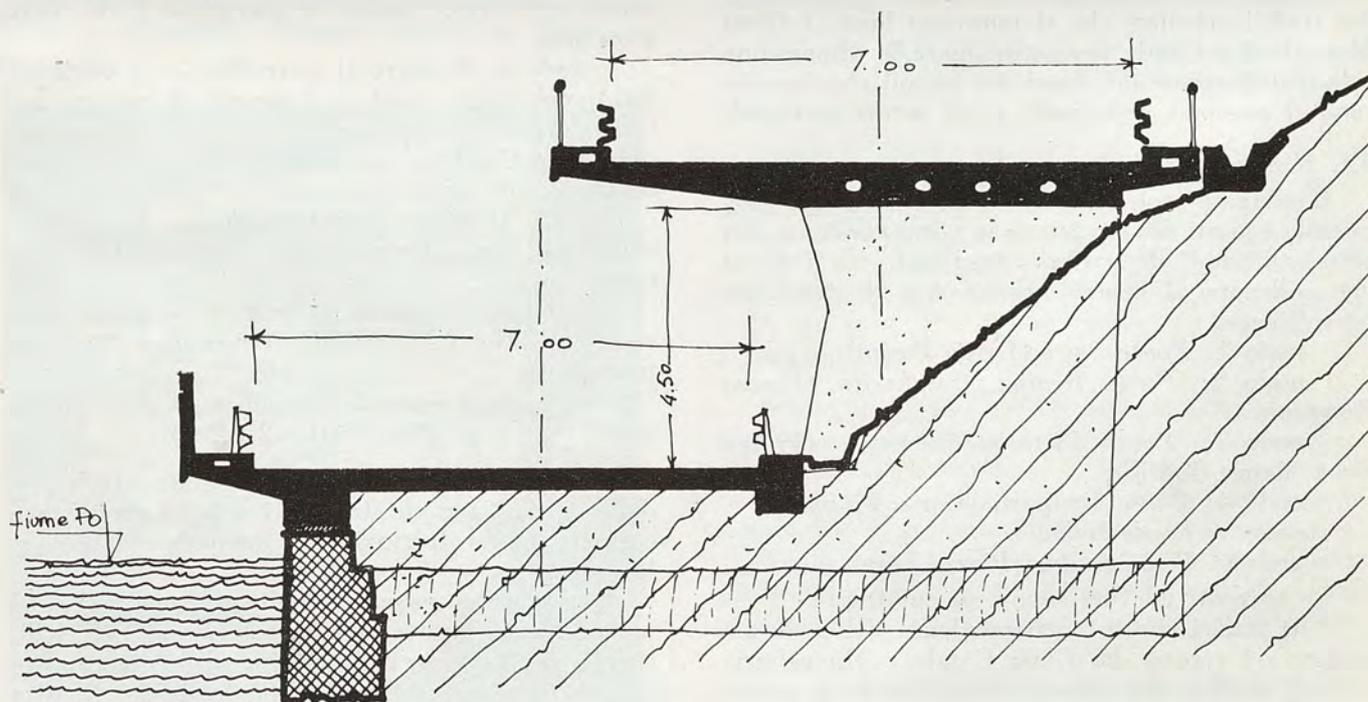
Sezione tipo con sedi parzialmente sovrapposte.
